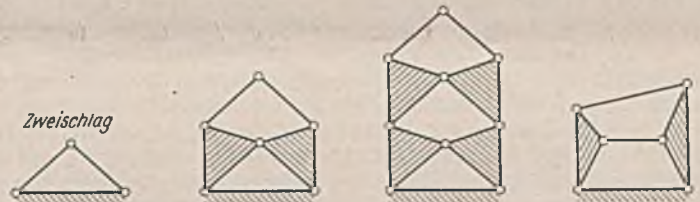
bis 2b. Fachwerksaufbau durch Zweischläge. Abb. 2c. Durch Aufbauänderung aus dem Fachwerk der Abb. 2a herstellbares Scheibenfachwerk.
